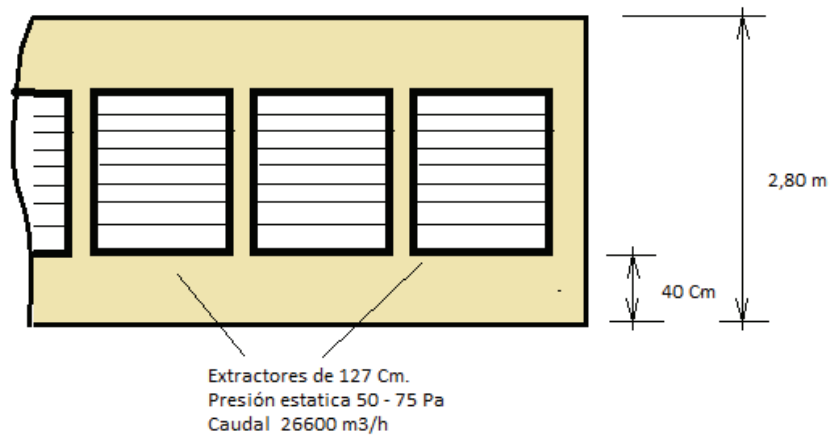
Descripción y dimensiones de los extractores, (Fuente: Autor)
